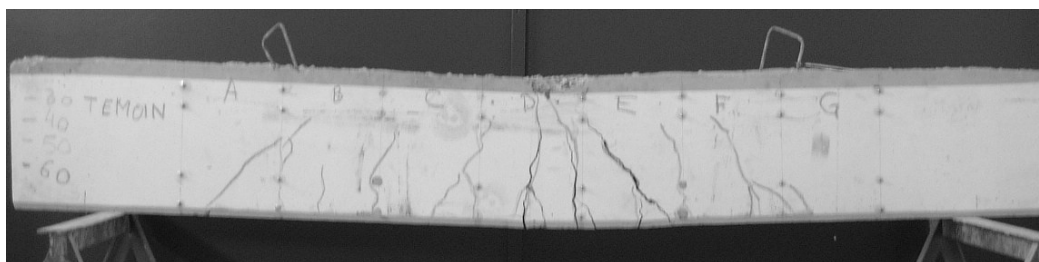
Faciès de fissuration de la poutre TEMOIN.
